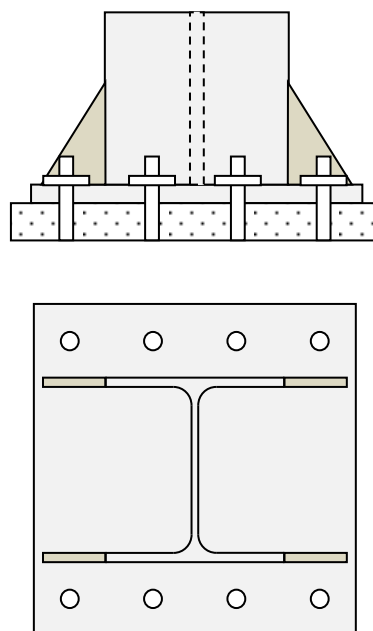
Raidisseurs dans le prolongement des semelles du pied de poteau
